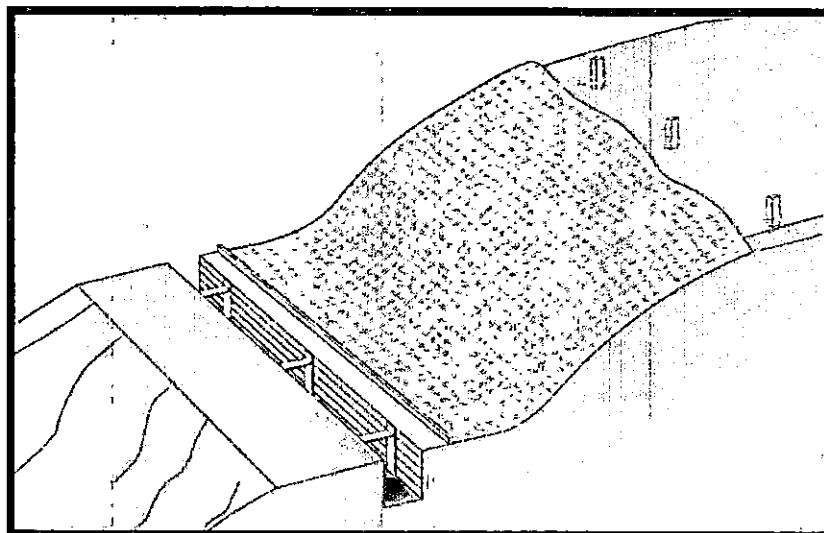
Excavación protegida con estructuras denominadas "pantallas: apuntaladas, sujetas, empastadas o en oscilación" y excavación mixta con paredes en taludes y con paredes protegidas por pantallas
